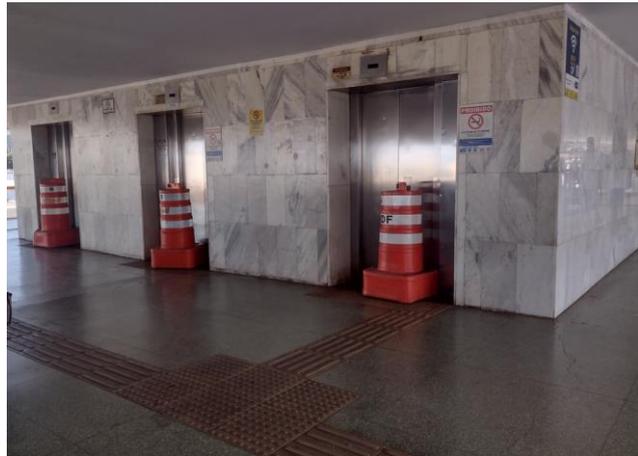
Elevadores localizado sentido Conjunto Nacional.
